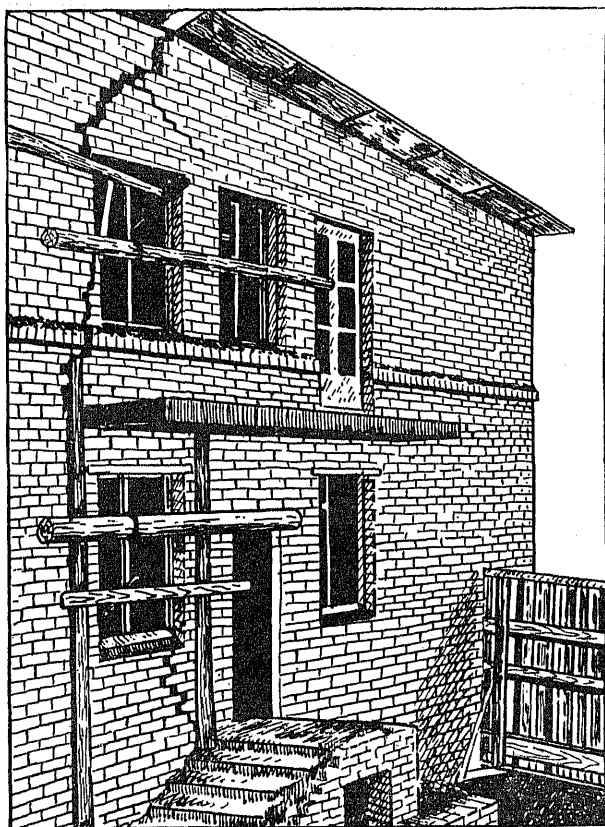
Деформация кирпичной стены здания при оттаивании промерзшего грунта под фундаментами со стороны подвала
